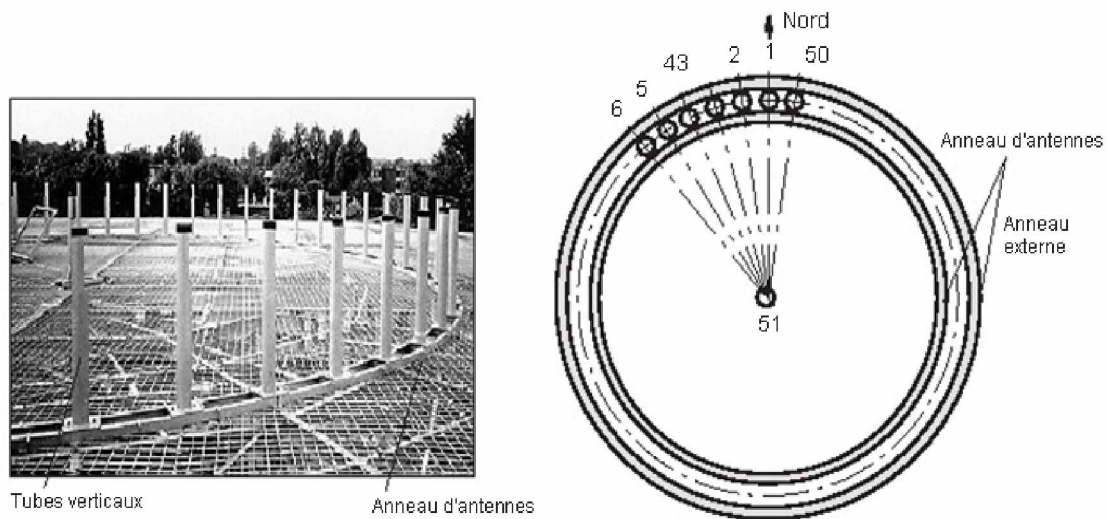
Installation des tubes verticaux et point d'installation de l'antenne 1.
